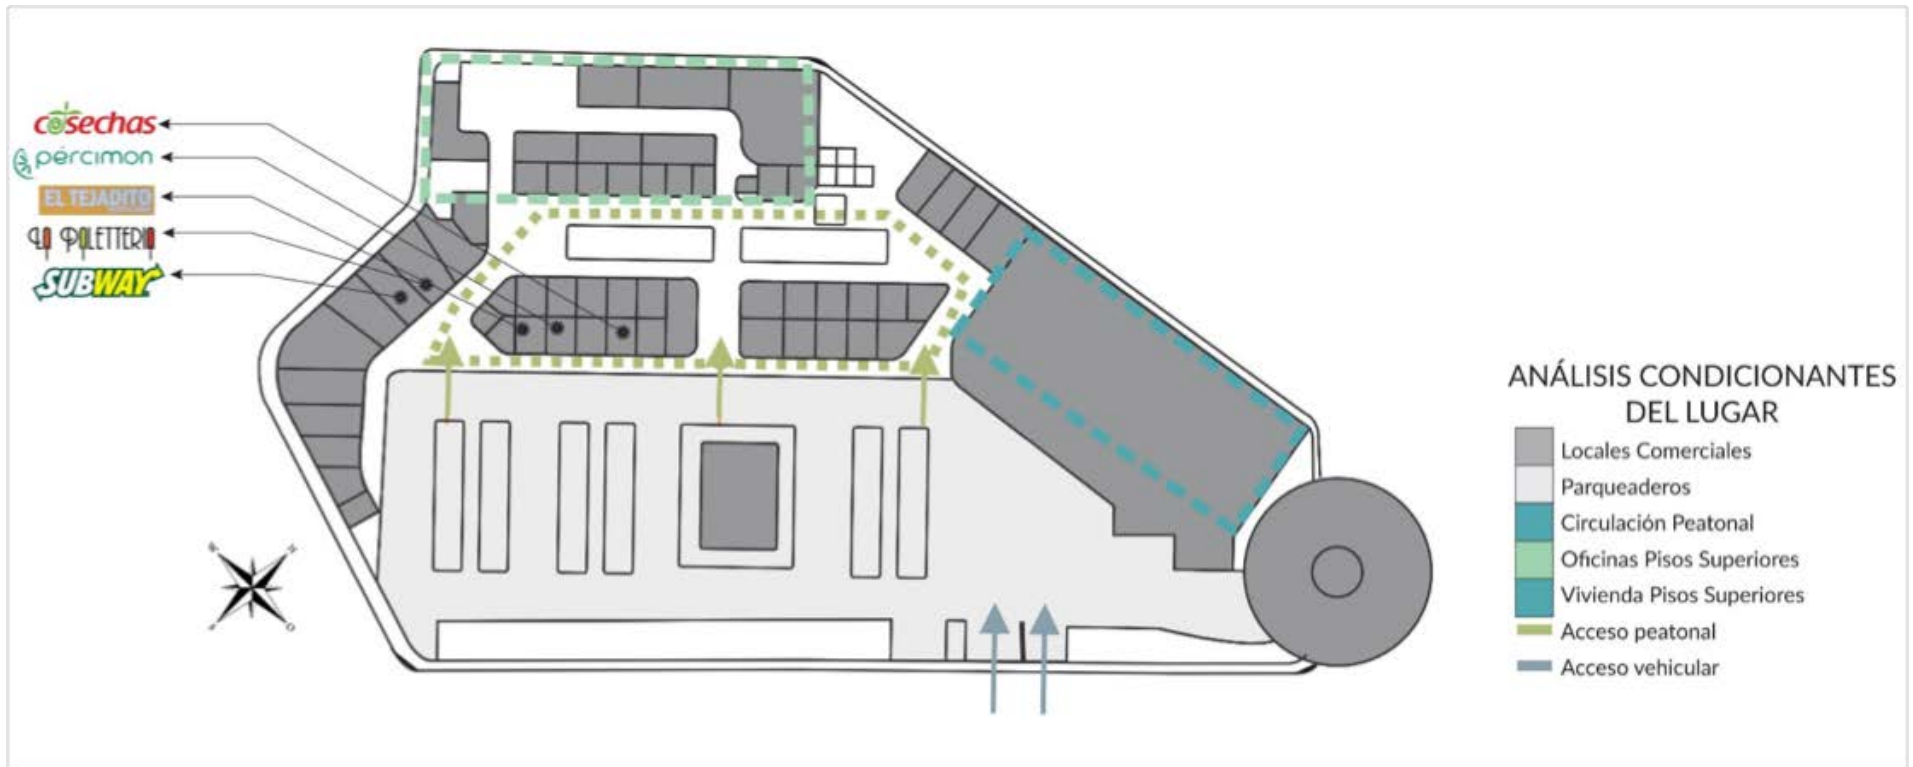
Esquema de planta arquitectónica de primer piso de el Mall del Este, donde se observa distribución de locales comerciales.
